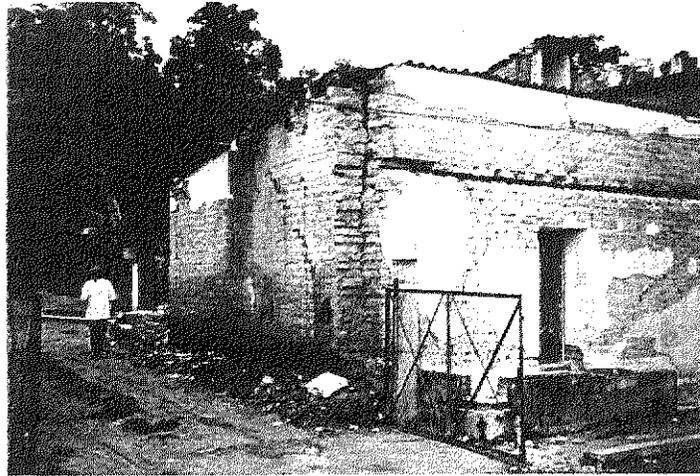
Daño en edificación de adobe sin liga entre muros ortogonales
